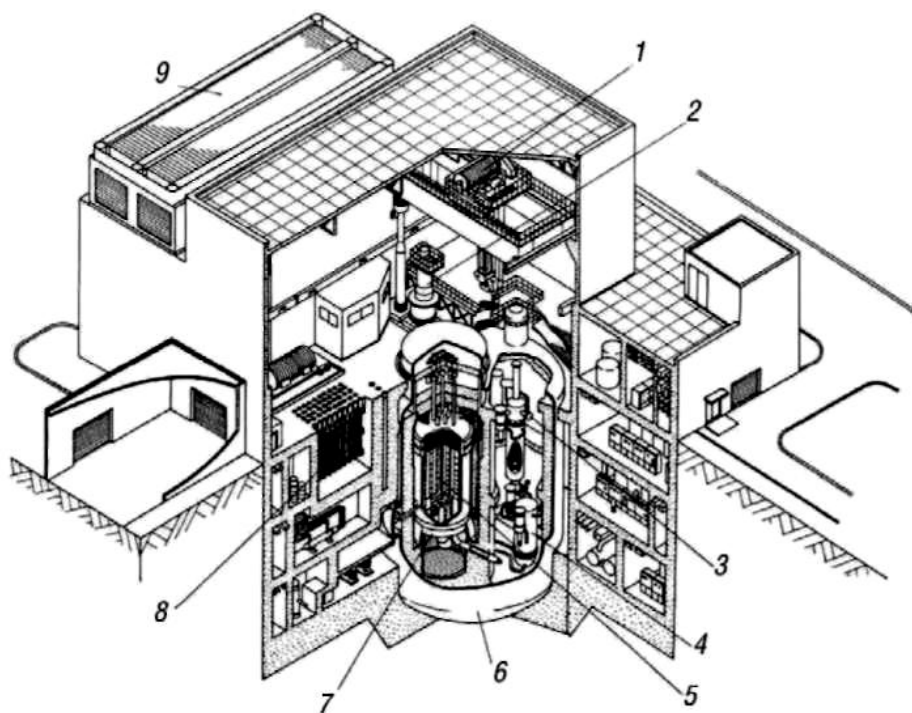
Здание реактора HTTR: 1 – подъемный кран; 2 – перегрузочная машина; 3 – промежуточный теплообменник; 4 – охладитель с водой под давлением; 5 – активная зона; 6 – реактор (корпус контейнмента); 7 – корпус реактора; 8 – хранилище отработавшего топлива; 9 – воздушное охлаждение
